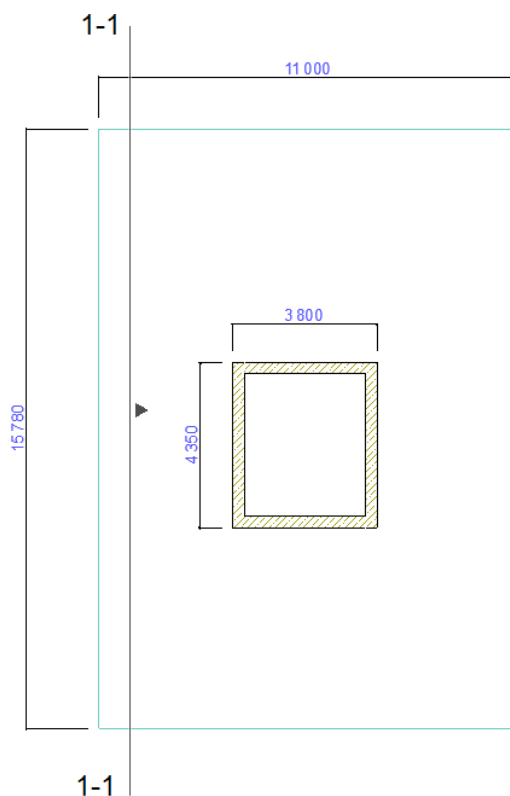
Схематичное расположение разреза на плане кровли
